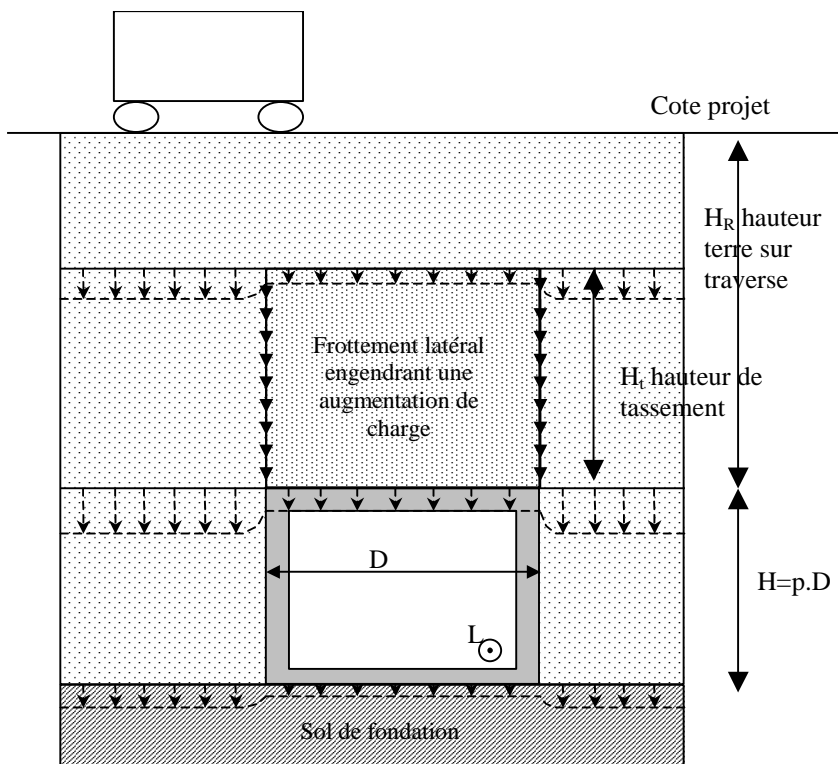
Coupe transversale caractérisant le tassement des terres autour d'un cadre
